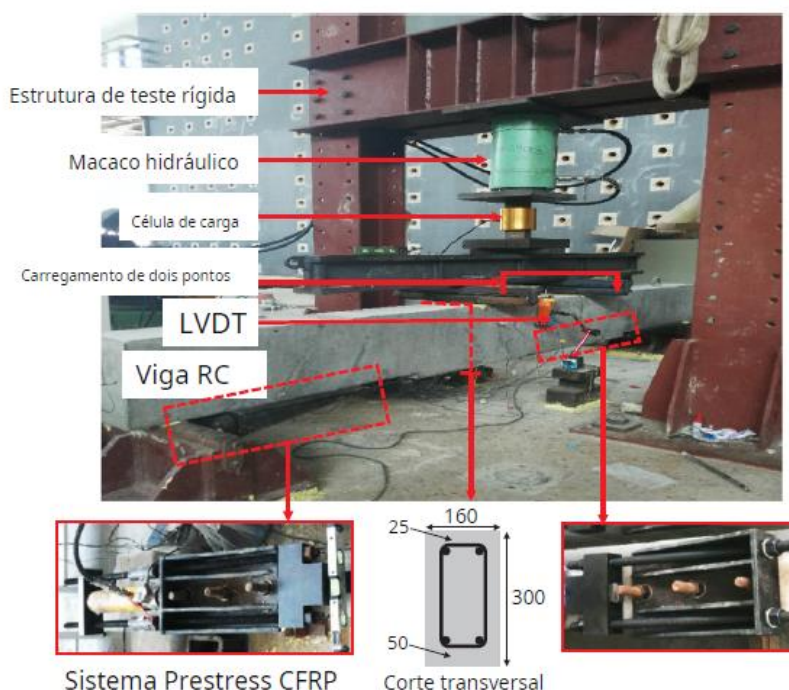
Configuração de teste da viga reforçada com CFRP pré-tensionado e configuração de pré-tensão (Rashid *et al.*, 2019).
